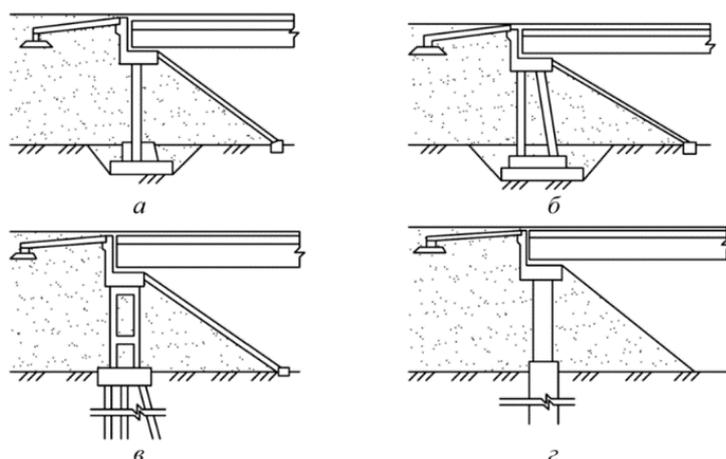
Примеры обсыпных устоев: а – стоечный устой на фундаменте мелкого заложения; б – козловой устой на фундаменте мелкого заложения; в – рамный устой на свайном фундаменте; г – безростверковый устой на буровых сваях
